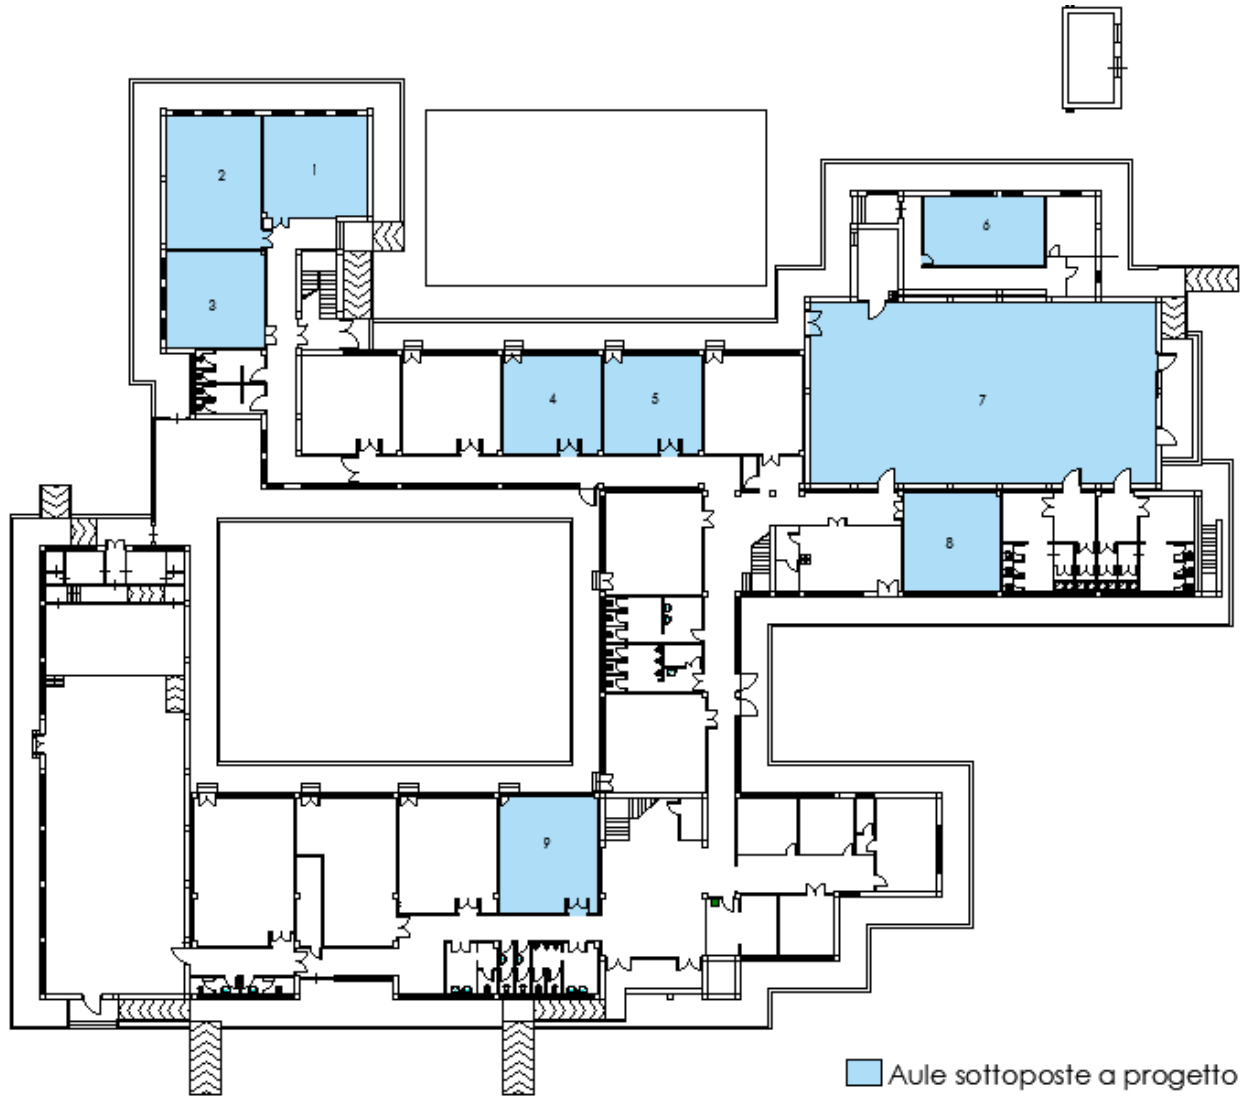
Planimetria piano primo_plesso via Pigno, scuola secondaria di I grado
